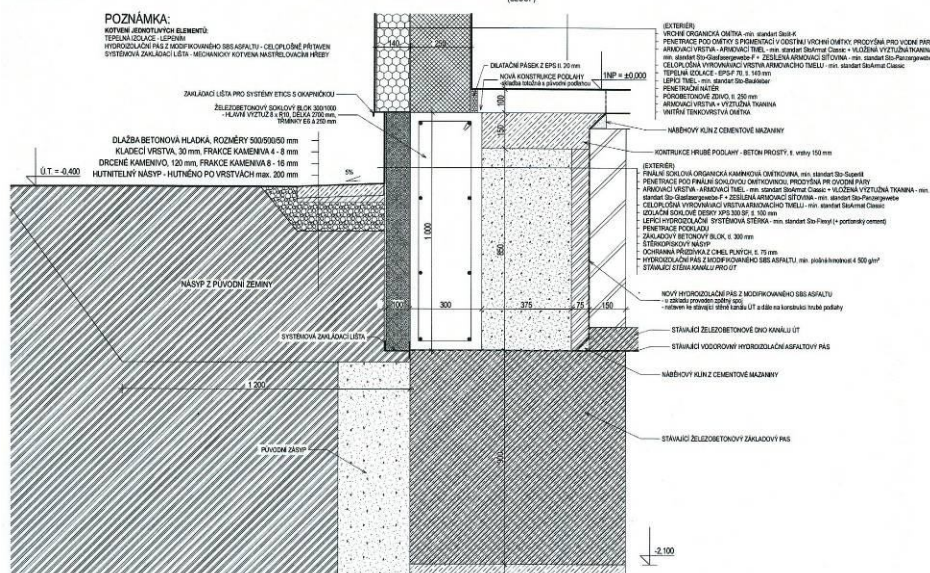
DETAIL ŽELEZOBETONOVÉHO VĚNCE
